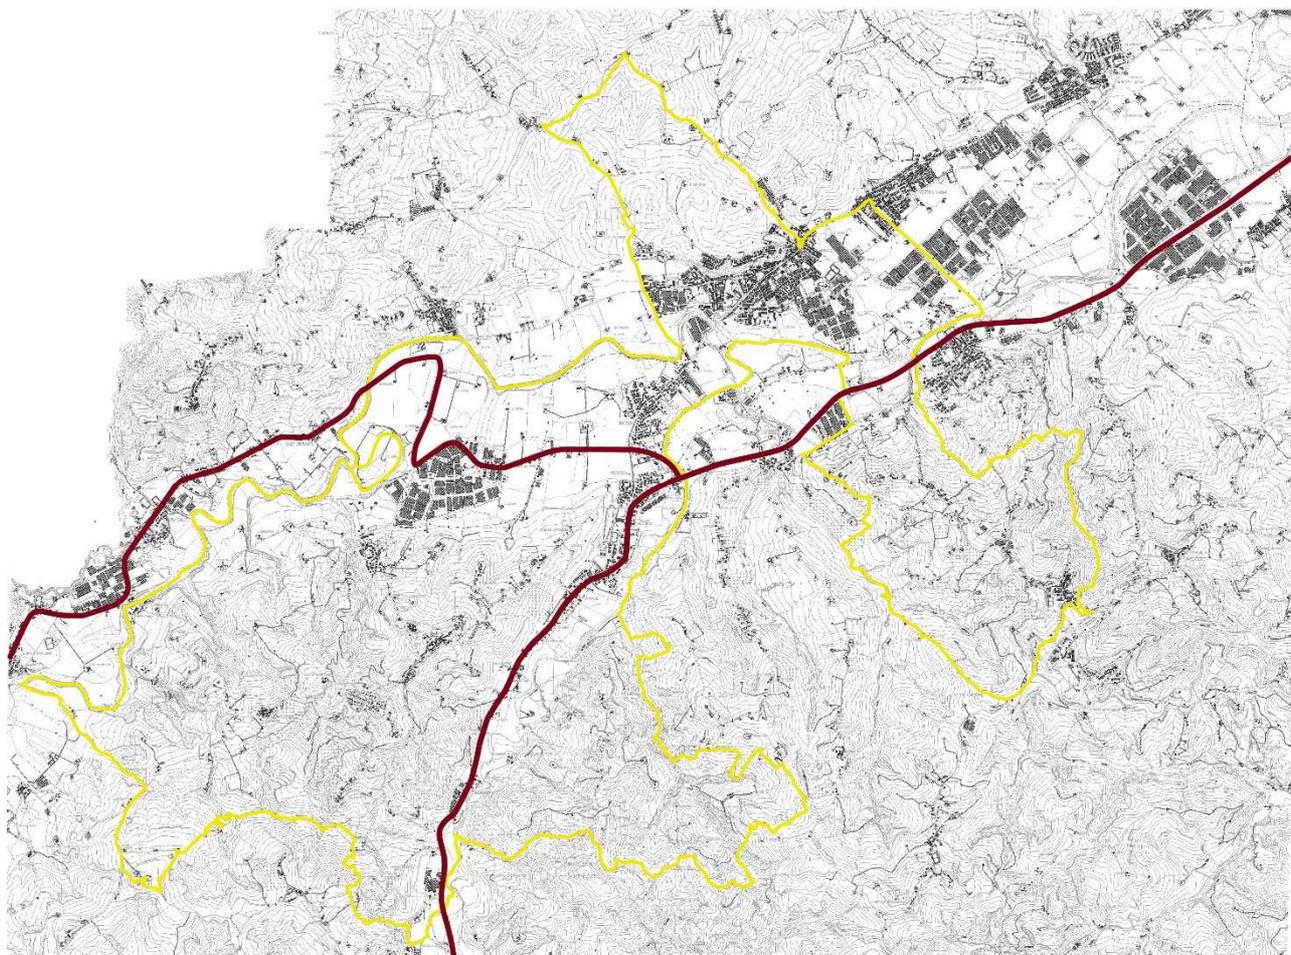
Planimetria generale dell'intervento e sezioni tipologiche
